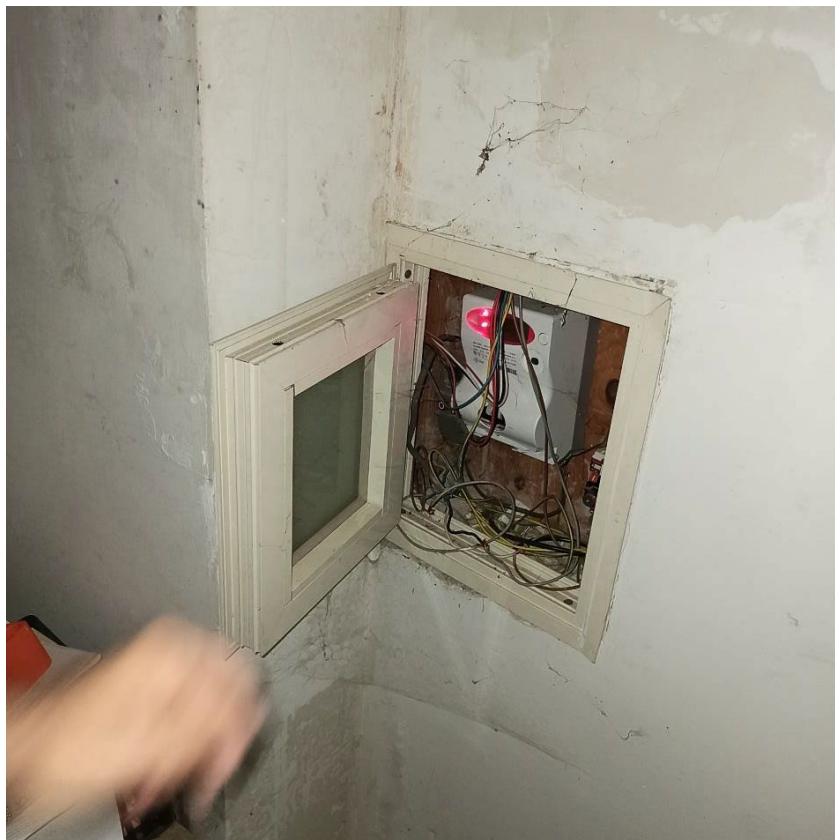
fornitura ENEL al piano terra dell'immobile negozio (foto da sopralluogo del 30/04/2024)
